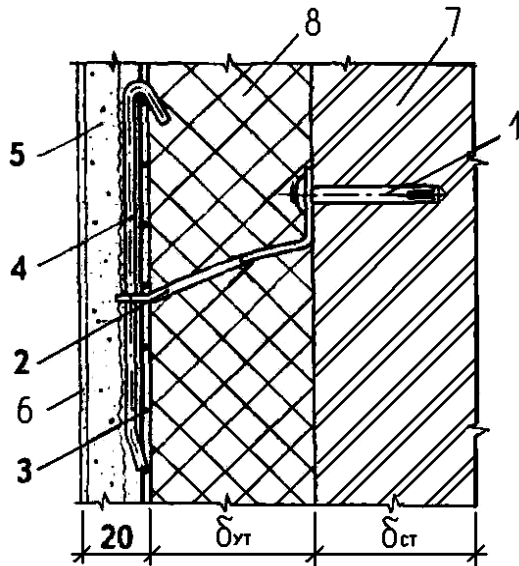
Багатошарова конструкція стени системи «Термофасад» с ефективною теплоізоляцією:
